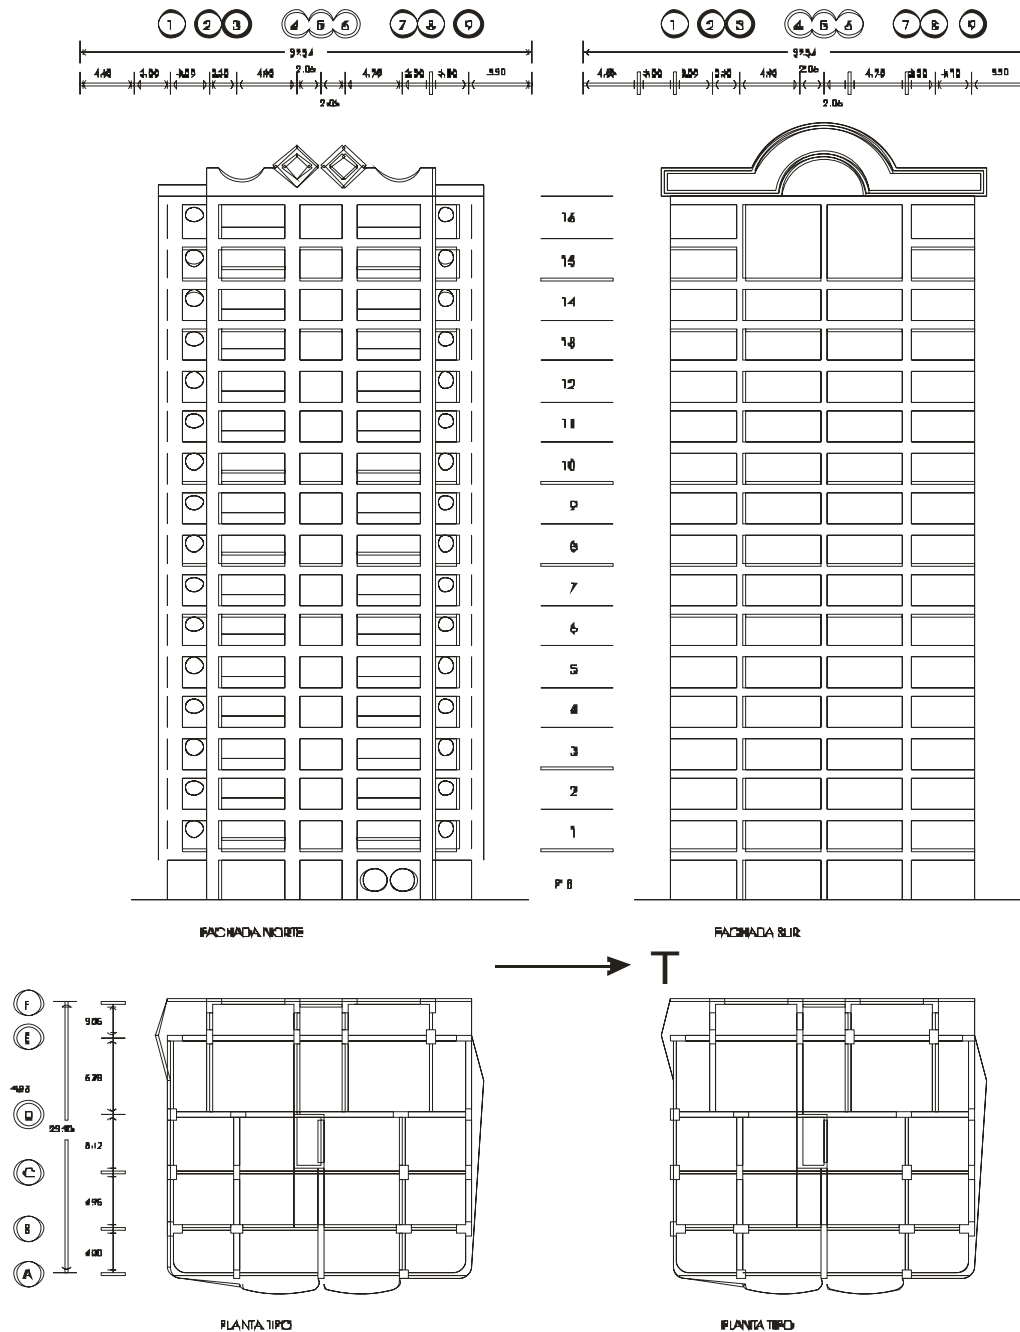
Fachadas Norte y Sur del edificio Oasis (Taborda, 2004)
